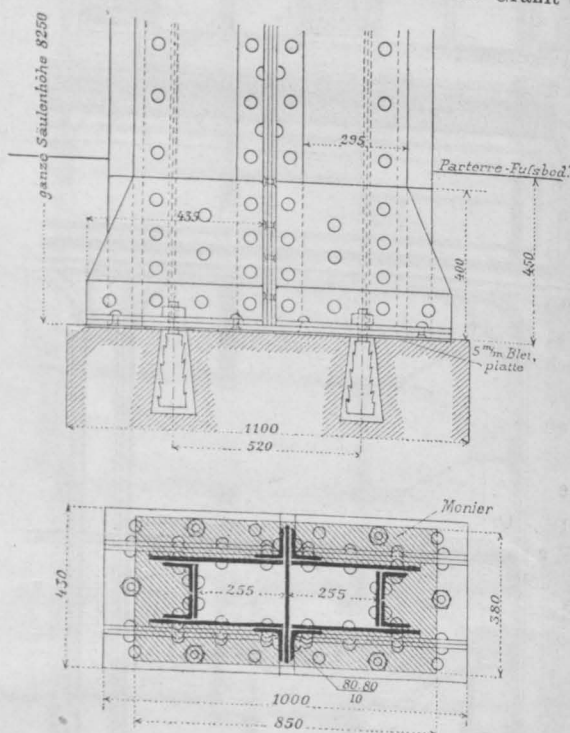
Aufriss und Grundriss der eisernen Façadenständer im Parterre.
